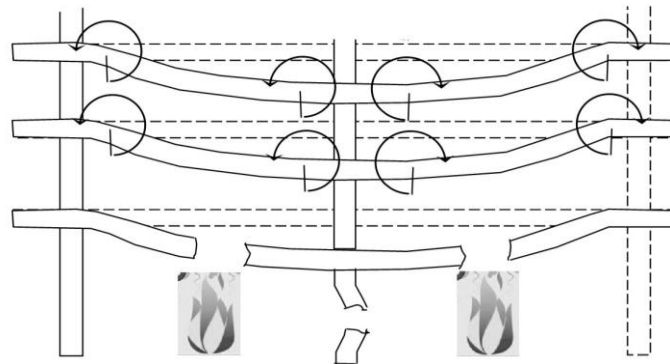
Розрахункова схема для розрахунку прогресуючого руйнування будівлі із залізобетонними конструкціями.
